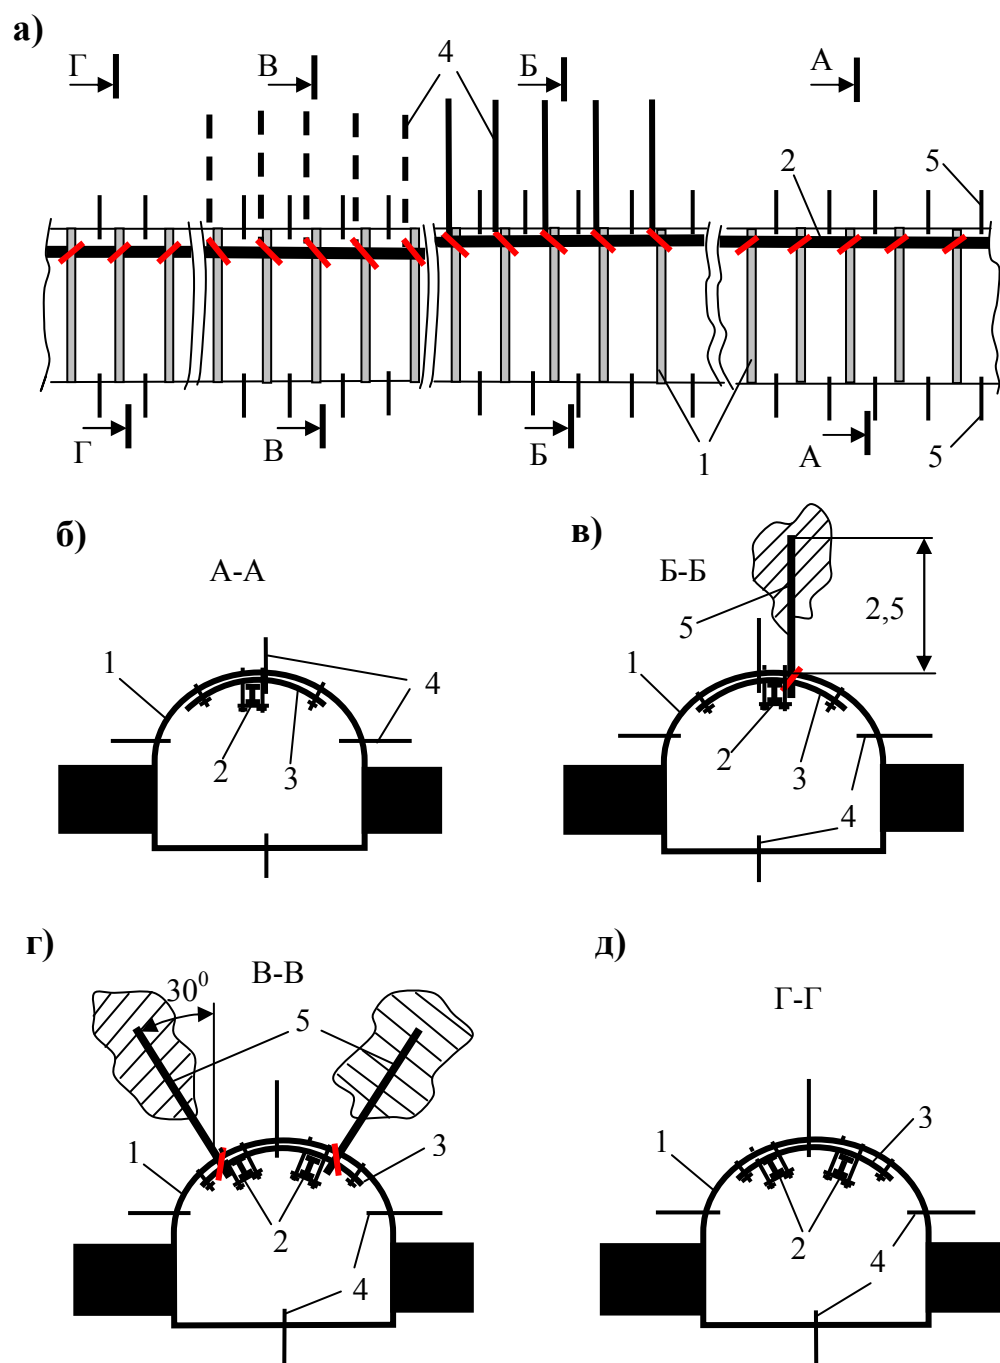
Схема расположения ПБДКУ вдоль вентиляционного ходка 4-й восточной лавы пласта с<sub>11</sub> (а) и в поперечном сечении на контрольном и четырех экспериментальных участках (б-д): б) - при одной балке; в) при одной балке с одним химическим анкером; г) – при двух балках и 2-х химических анкерах; д) - при двух балках: 1 – комплекты арочной крепи; 2 – продольная двутавровая балка; 3 – сегмент жесткости; 4 – контурные реперы; 5 – сталеполимерные анкеры
